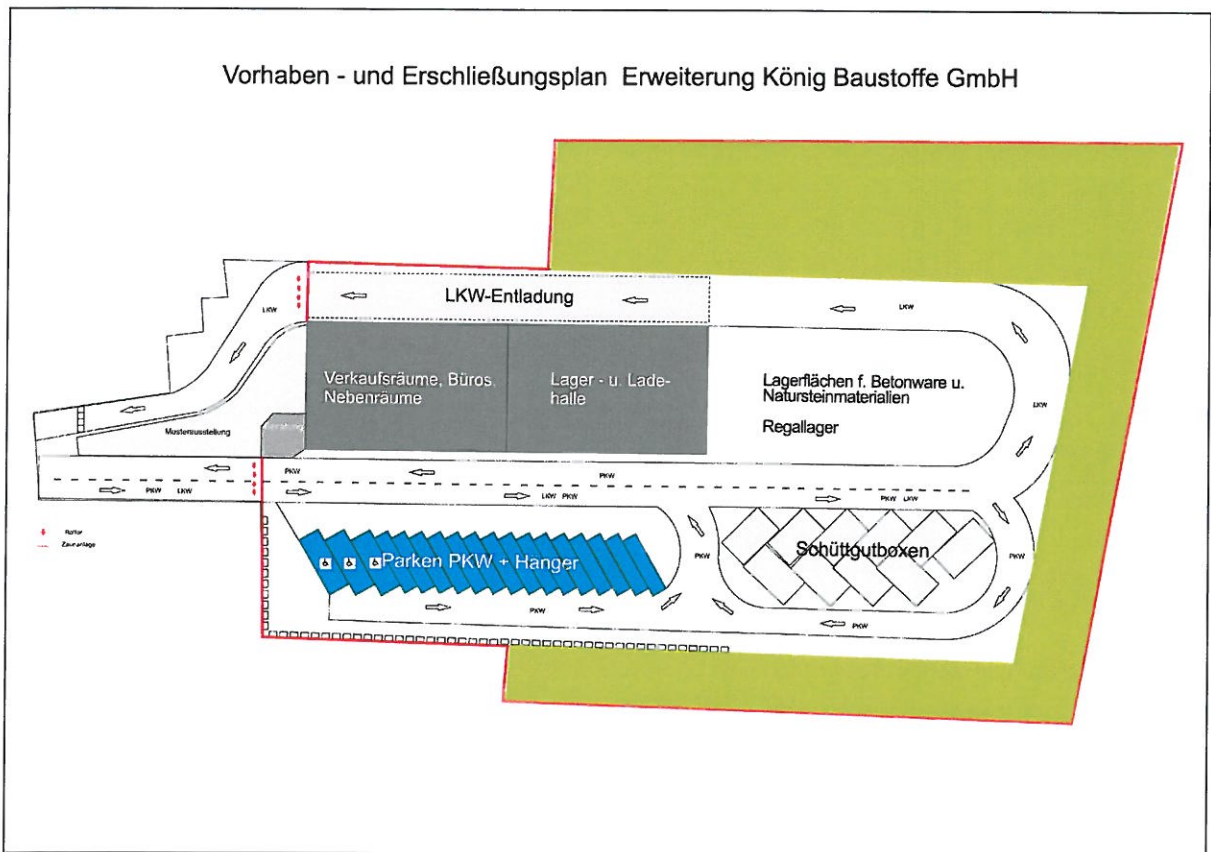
Vorhaben- und Erschließungsplan Erweiterung König Baustoffe GmbH
